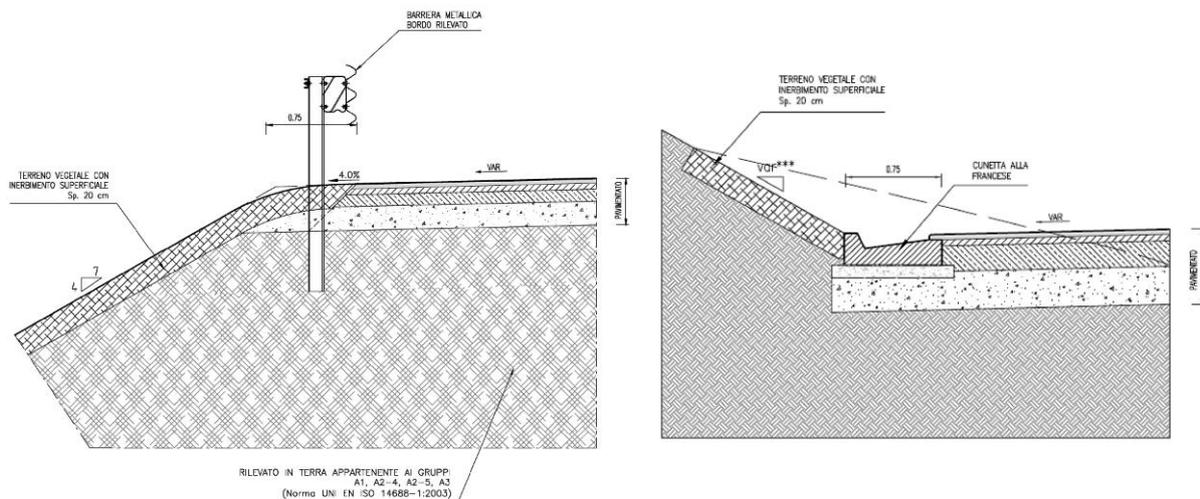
Sezione tipo margine esterno in rilevato e in trincea
